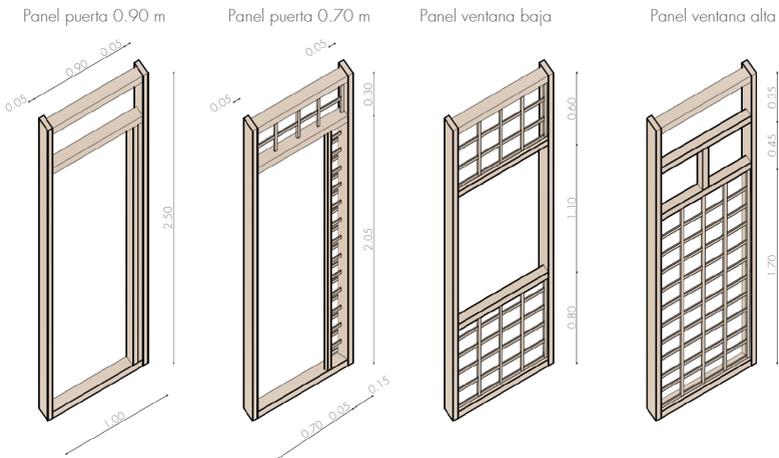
| Tipos de paneles. | Fuente: Autoría Propia (2024).
